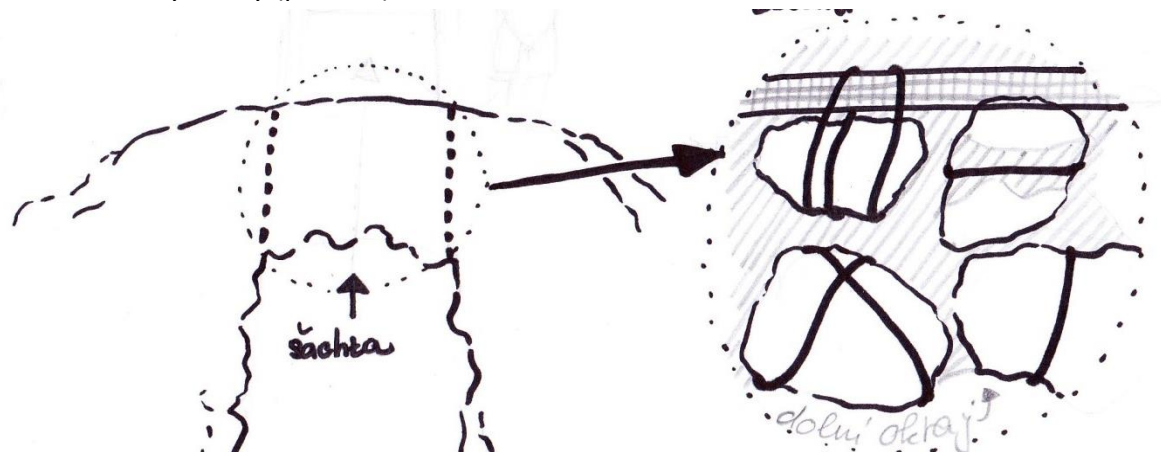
Jednodušší technika „do kříže“ [134], používaná u méně vyčnívajících kamenů, (zdola).
